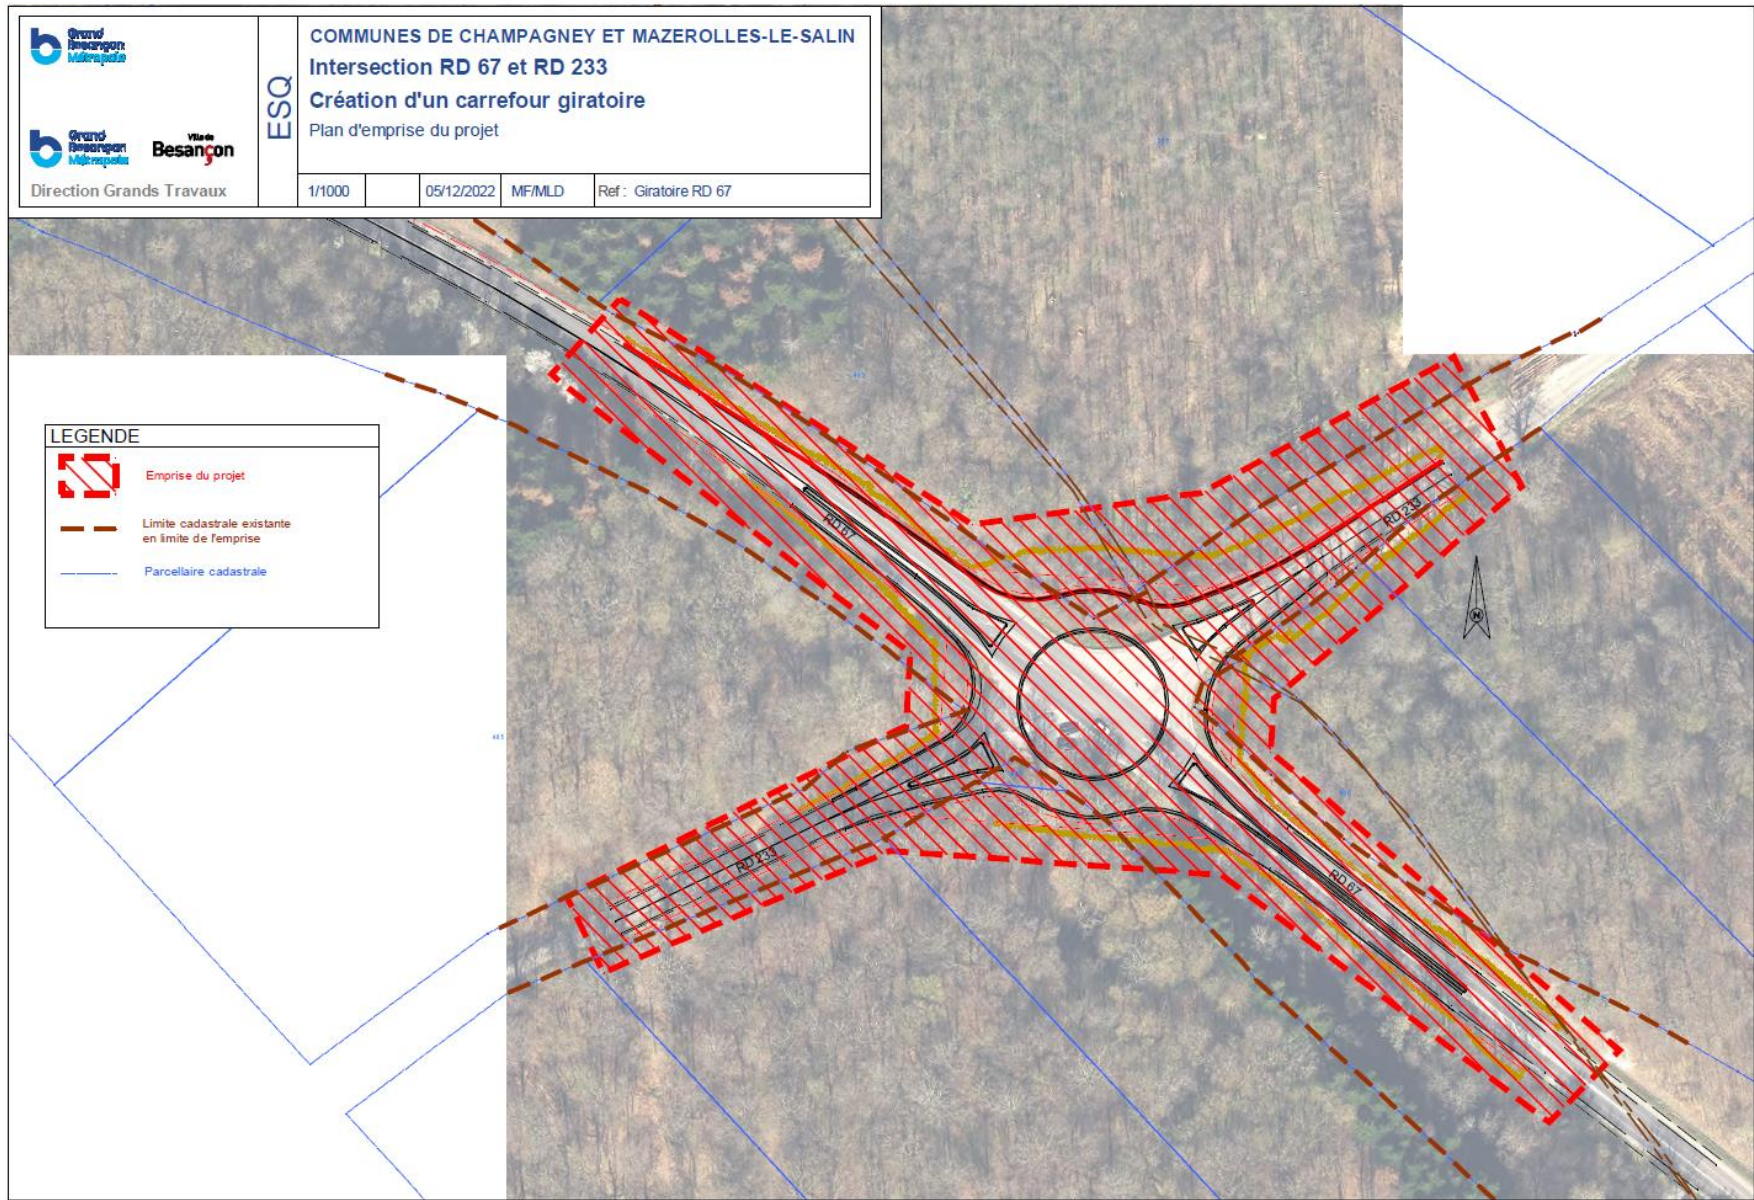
Plan d'emprise du projet (12/2022, GBM)
